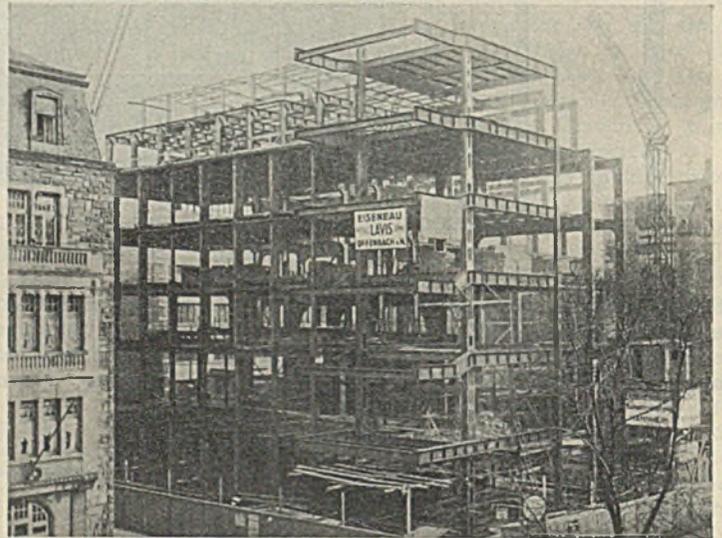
Turmkonstruktion mit den anschließenden Frontflügeln.
